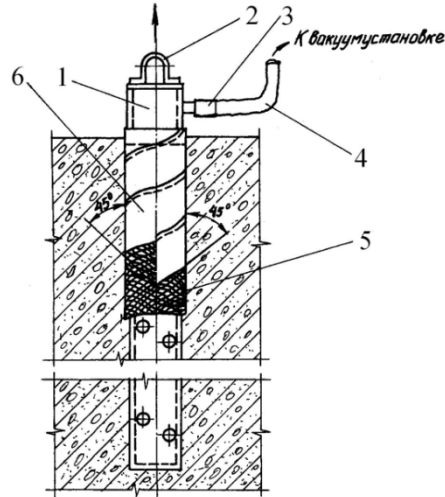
Вакуумтрубка с гибким сетчатым чехлом: 1 – металлическая труба; 2 – петля для извлечения вакуумтрубки; 3 – патрубок; 4 – соединительный всасывающий шланг; 5 – гибкий сетчатый шланг; 6 – лента из фильтровальной ткани
